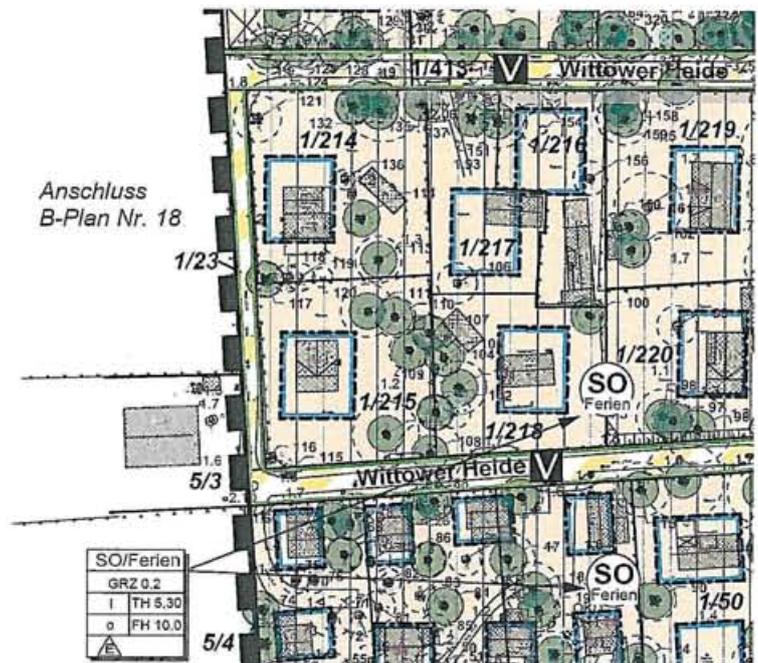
Ausschnitt Planzeichnung, Stand 3. Änderung und Ergänzung
